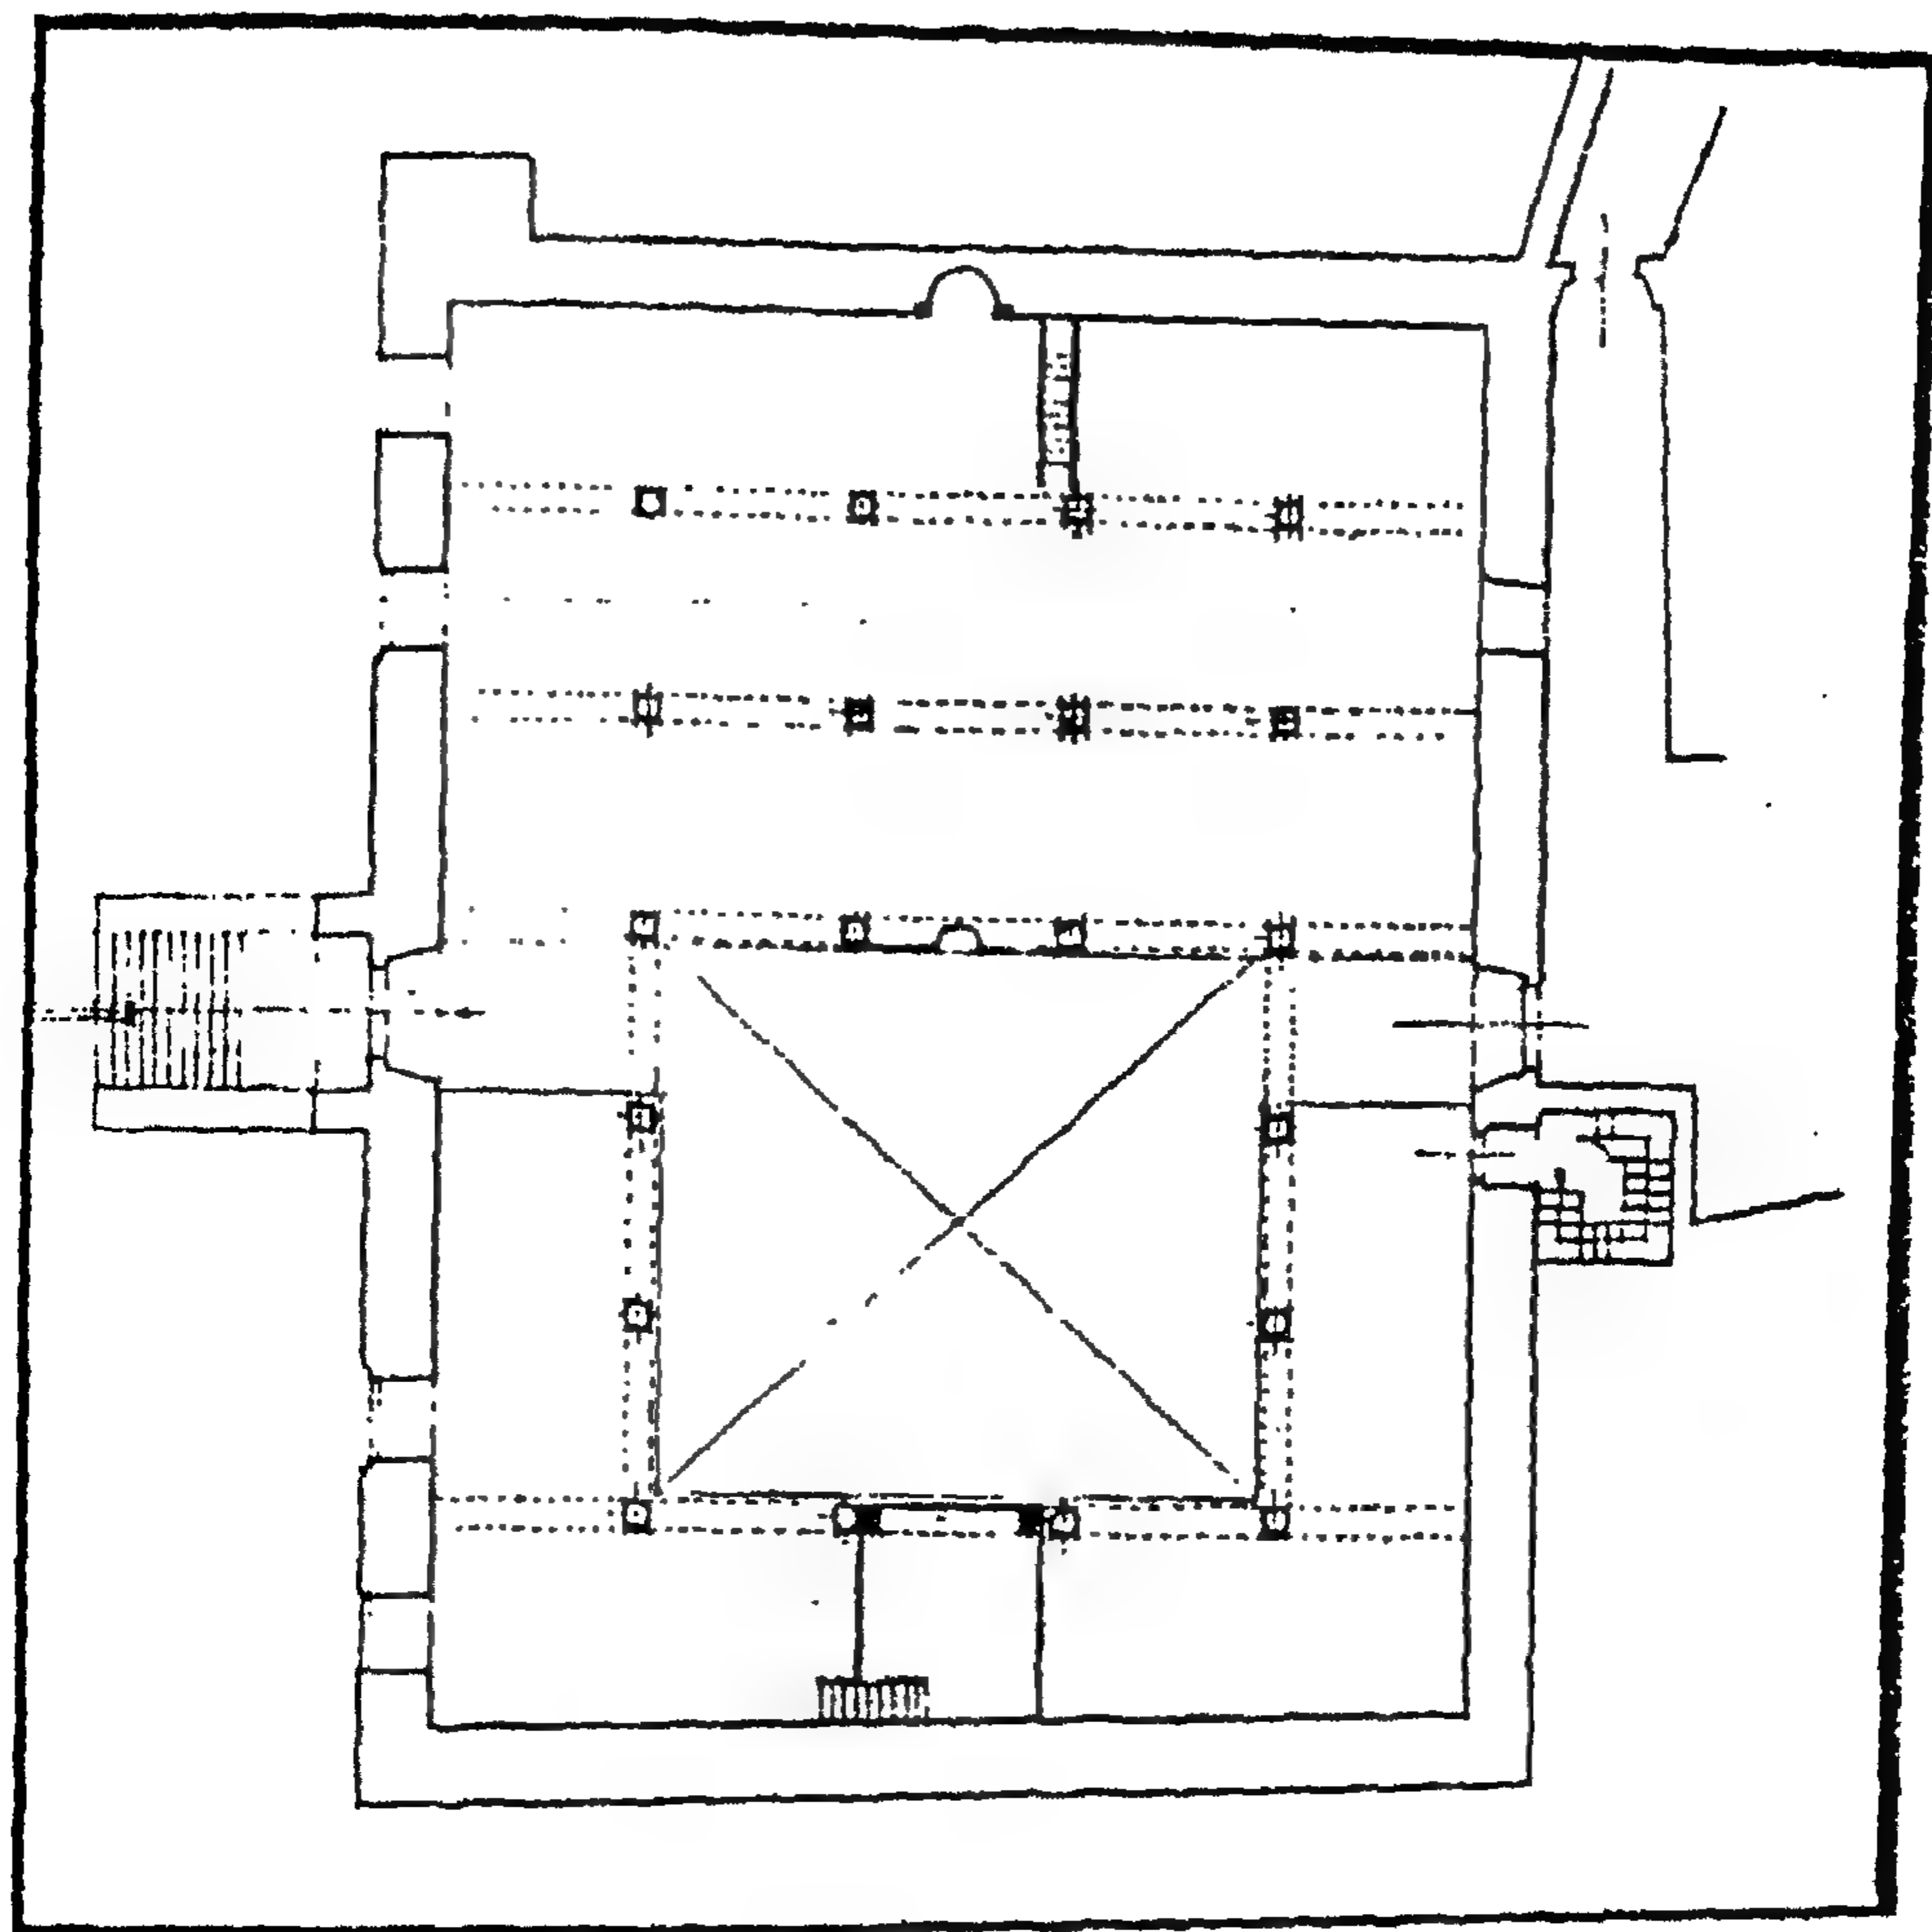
مسقط أفقي لمسجد الصالح طلائع بالقاهرة .
